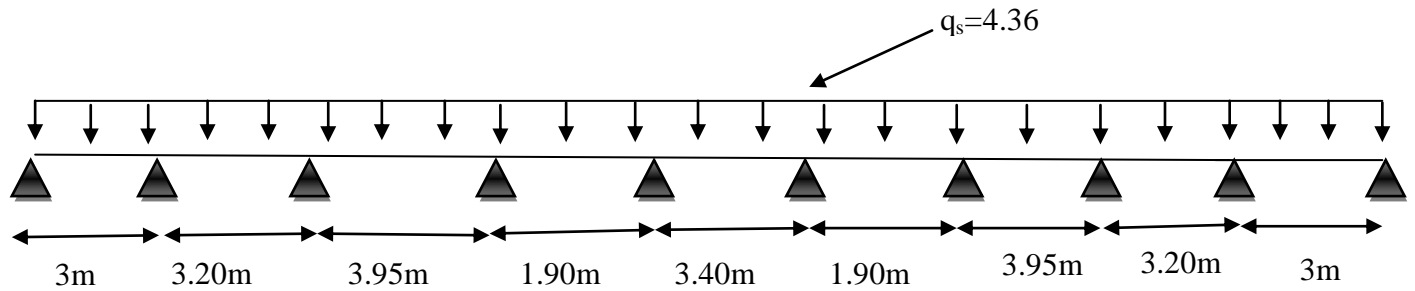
Schéma statique de la poutrelle à l'ELS
